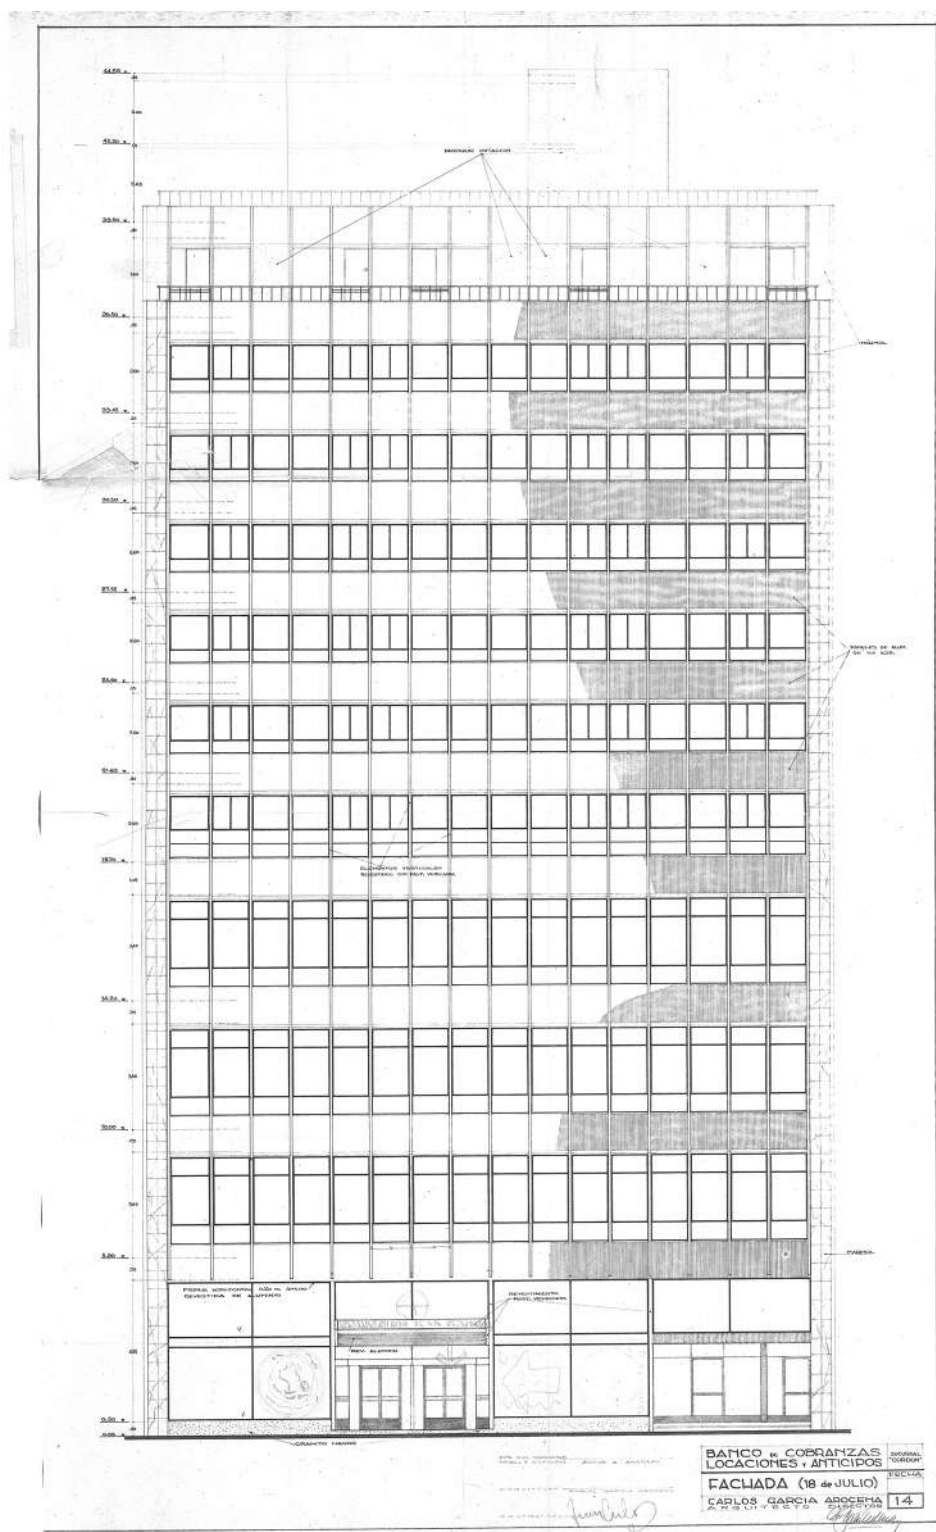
Lámina 14 del proyecto ejecutivo del BCLA: fachada sobre 18 de Julio.
